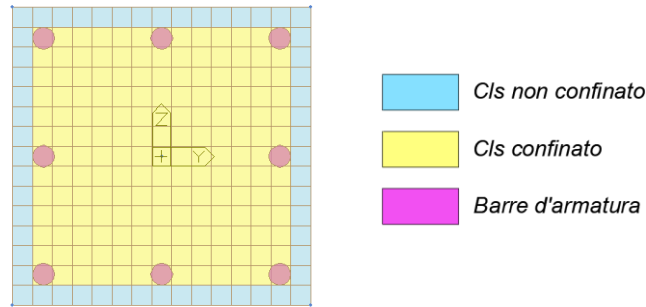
Sezione a fibre PIL_P1 e PIL_P2
